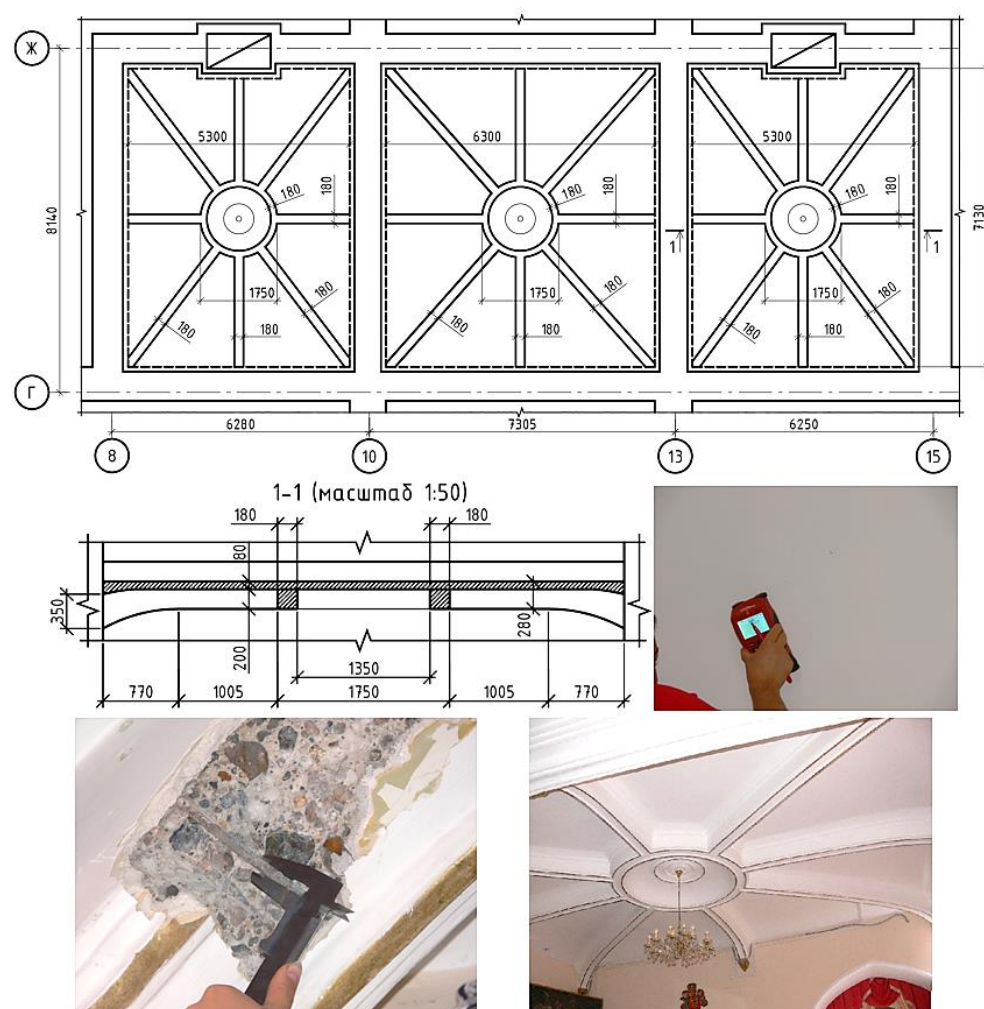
Определение конструкции перекрытия над фойе первого этажа
